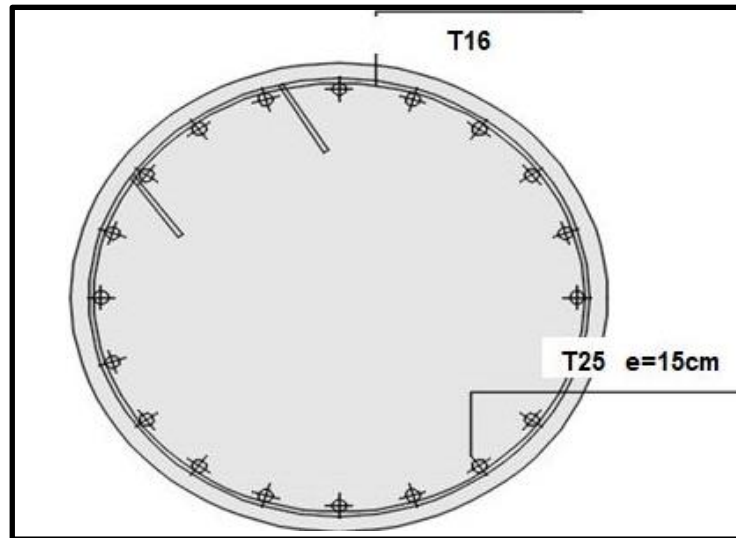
ferrailage des pieux (coupe 1)
